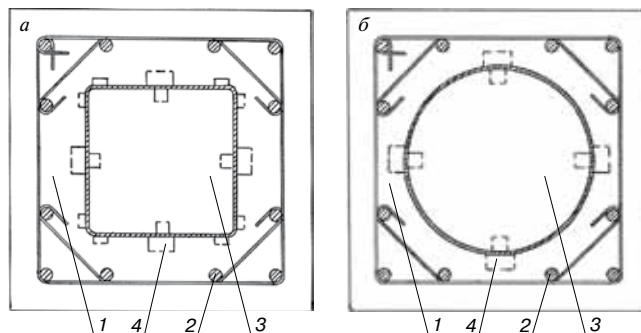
Поперечное сечение колонны 500×500 мм с трубобетонным элементом квадратного (а) и круглого (б) поперечных сечений с упорами на наружной и внутренней поверхностях трубы. Обозначения см. рис. 4
